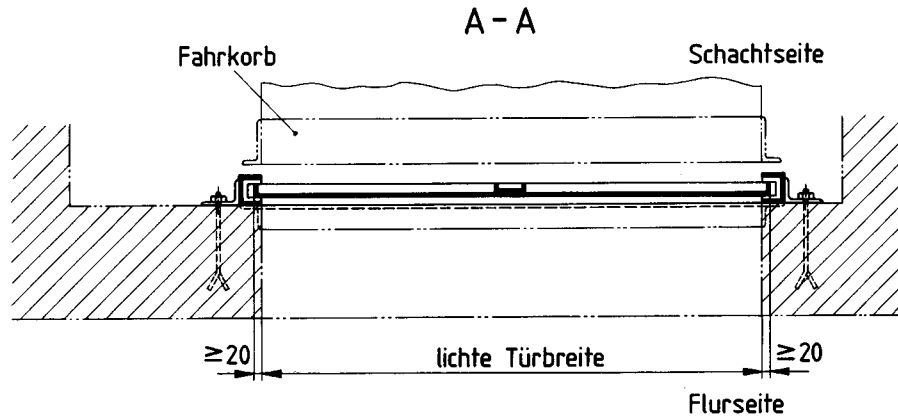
Vertikal-Schiebetür; Grundriß (Horizontalschnitt A - A)
